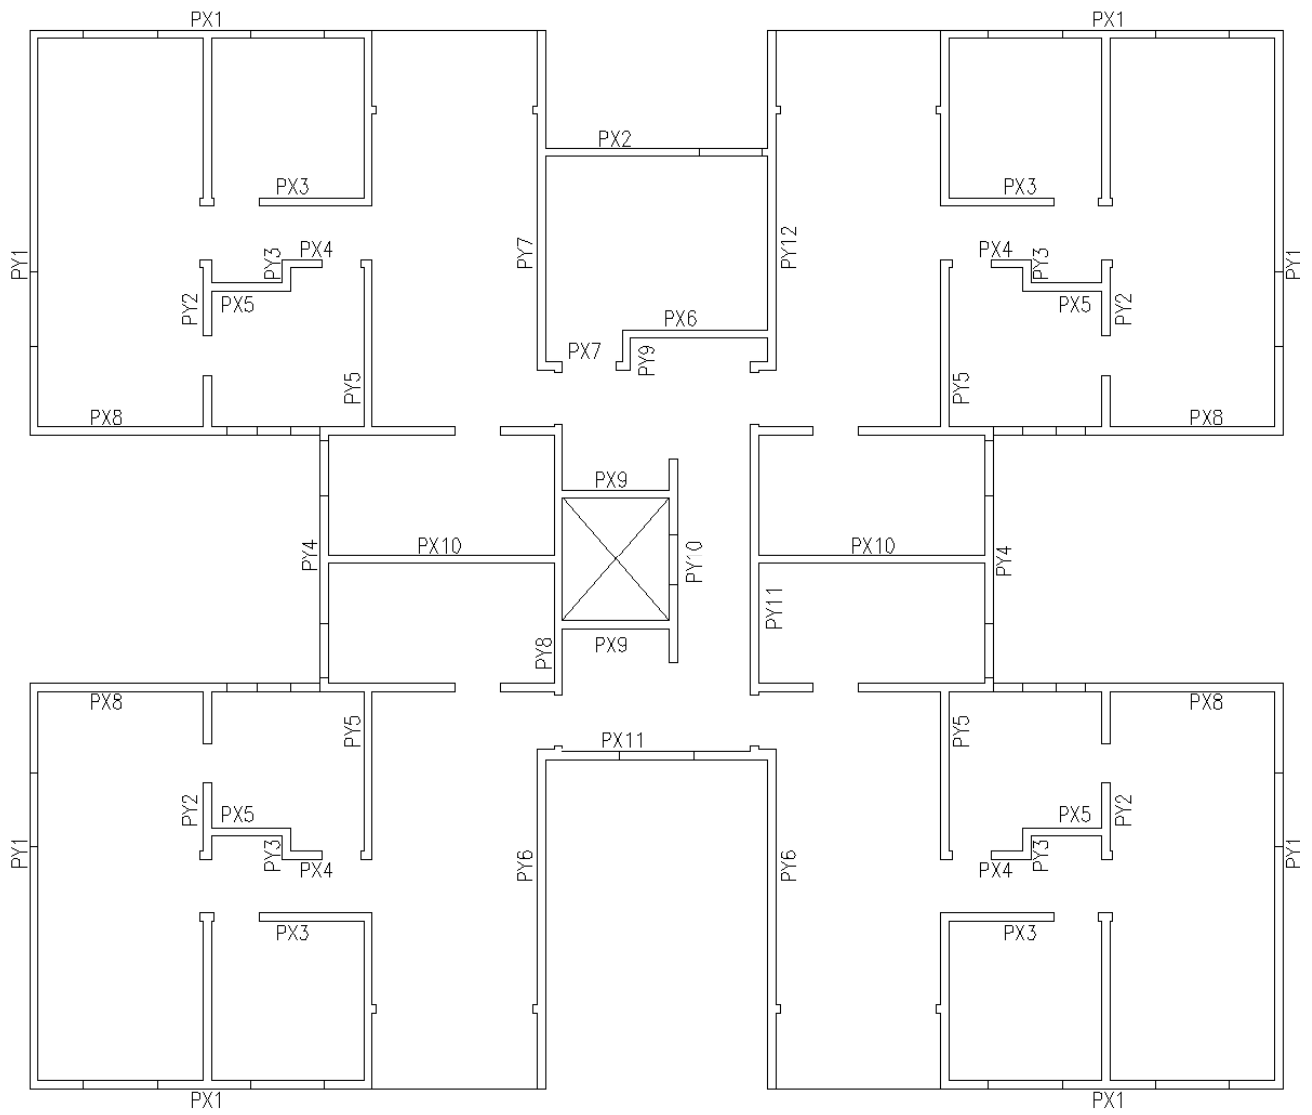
Paredes Estruturais do pavimento tipo
